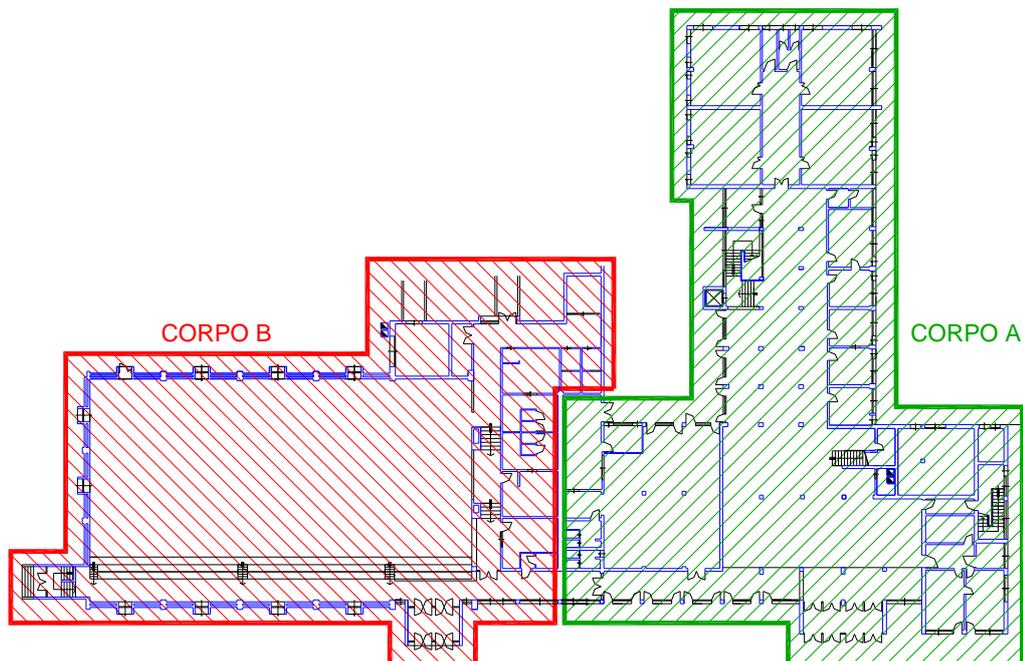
Planimetria del Plesso Scolastico ed individuazione delle unità strutturali.
